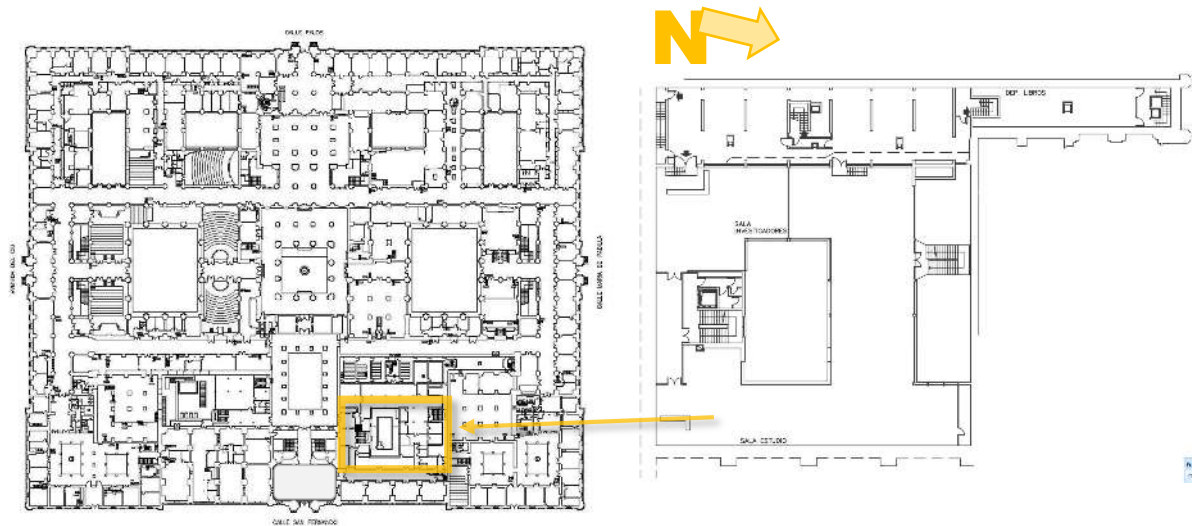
Planimetría de la Real Fábrica de Tabacos.
